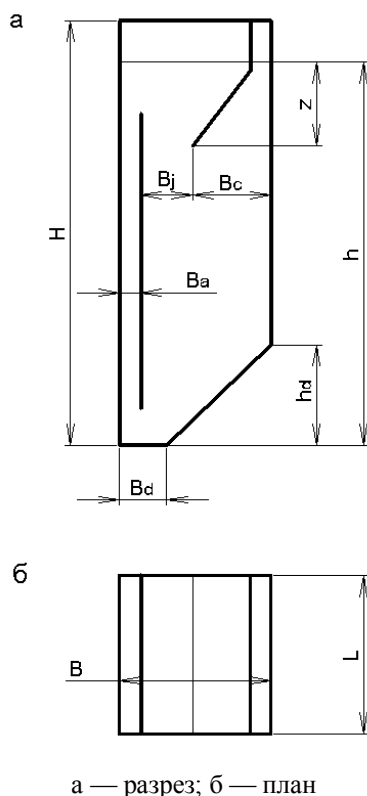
Обозначения размеров корпуса аэротенка-осветлителя
